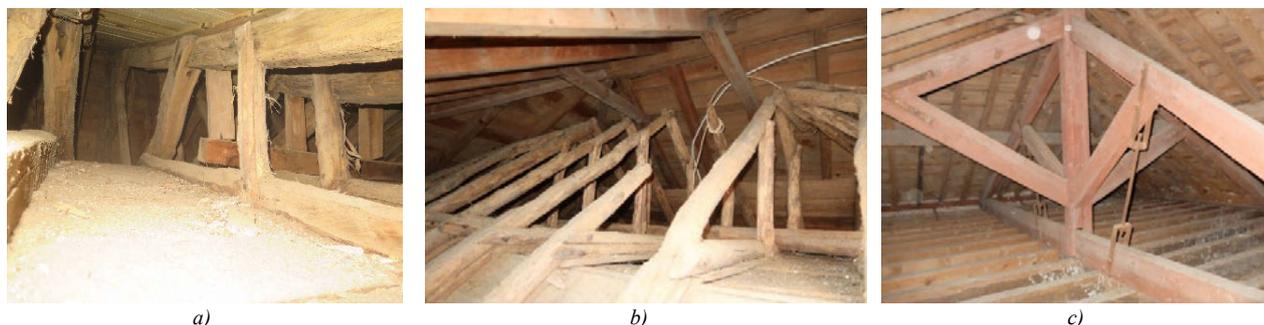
Ejemplos de la geometría de las estructuras existentes que constituyen las cubiertas del palacio
